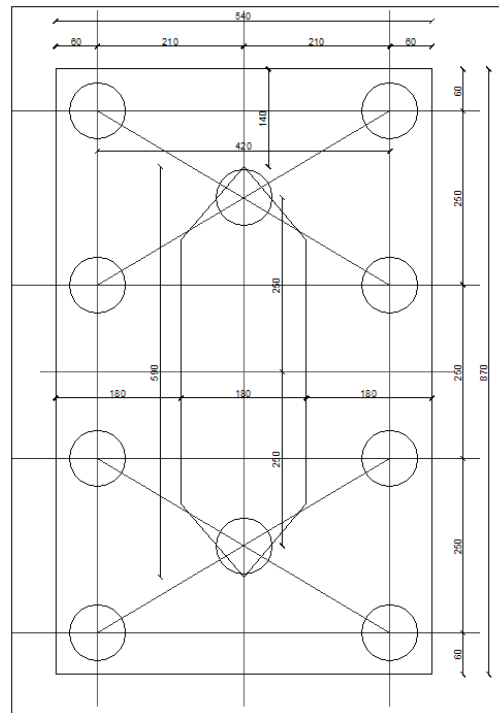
Piastra di fondazione per collegamento n.10 pali CFA
